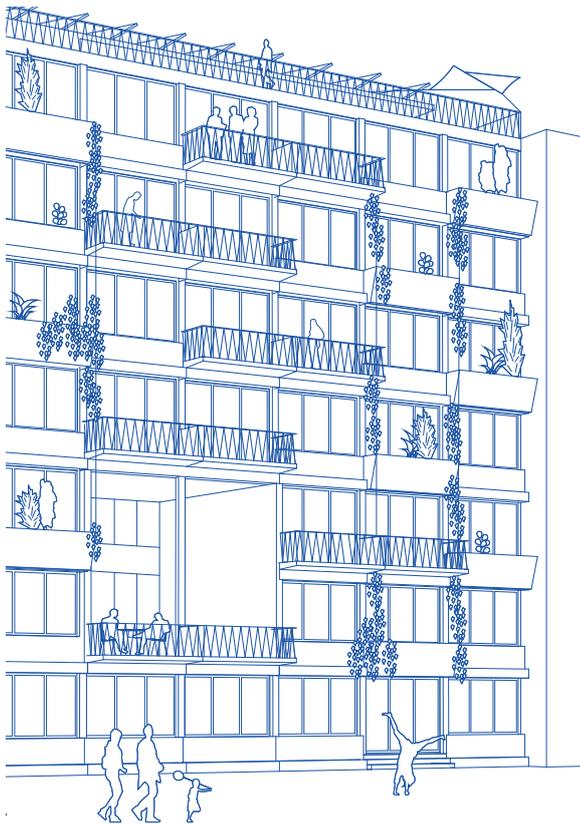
Überlegungen zur Fassade mit Balkonen + Pflanztrögen
